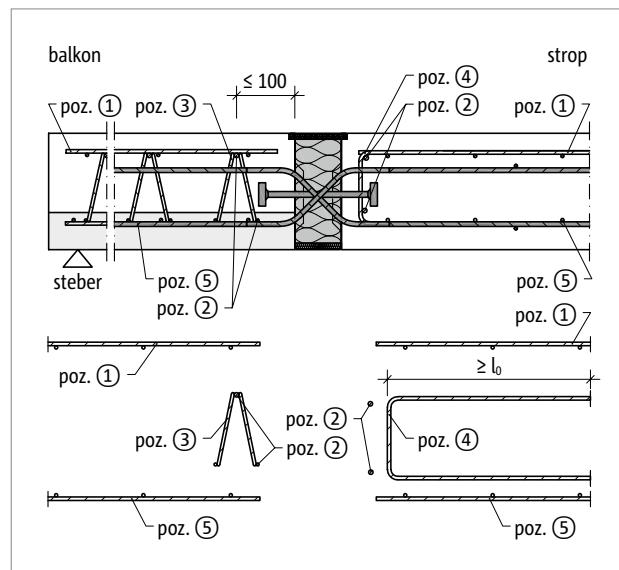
Schöck Isokorb® T tip QP: armatura na objektu
